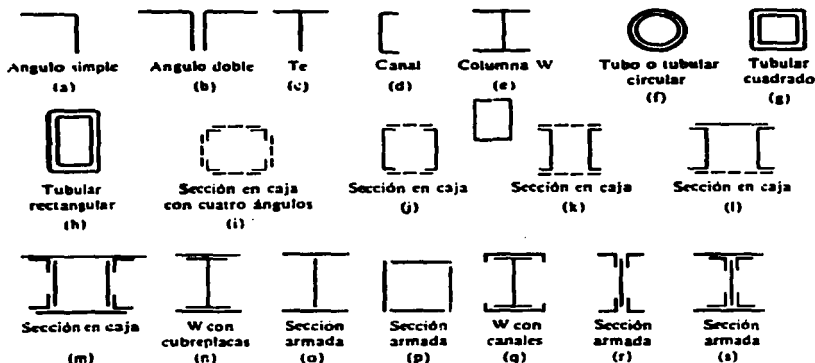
tipos de miembros a compresión (perfiles usados para columnas).
